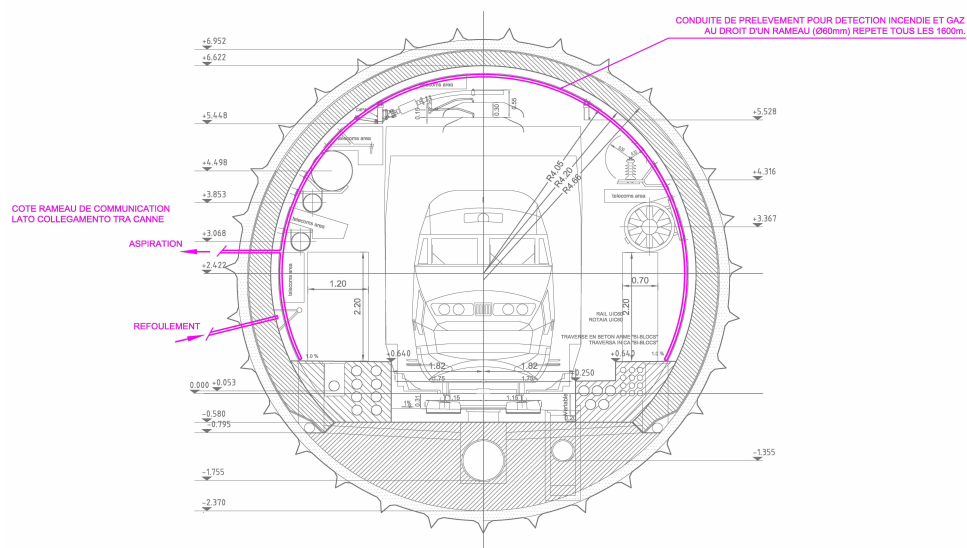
Coupe type en tunnel pour le système de prélèvement
